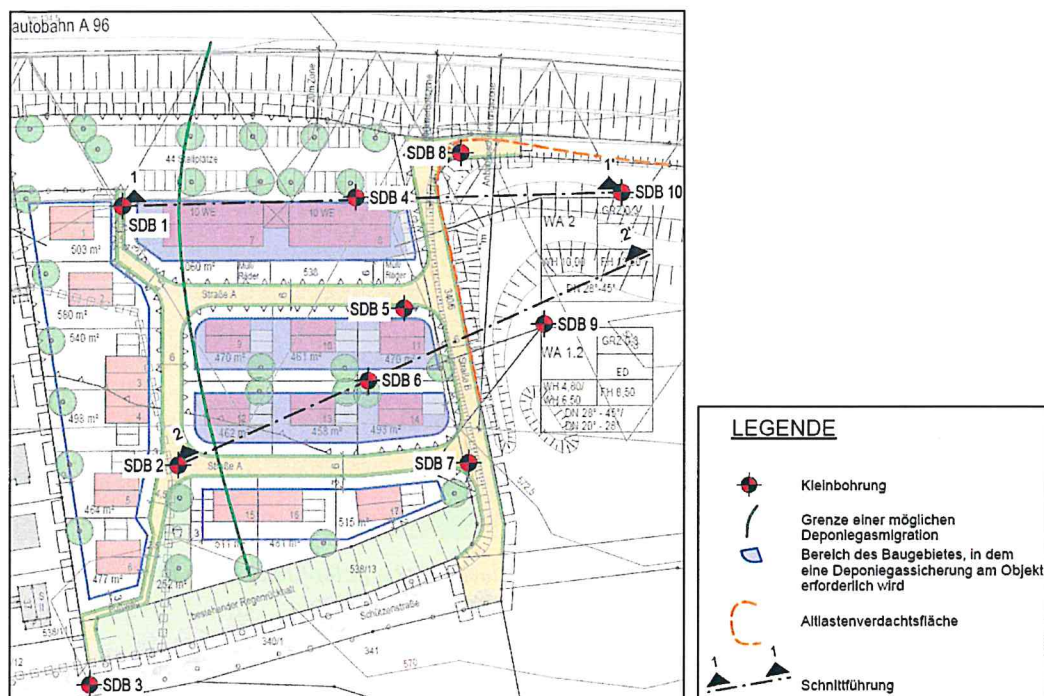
Lageplan mit erforderlicher Deponiegassicherung, ohne Maßstab,
